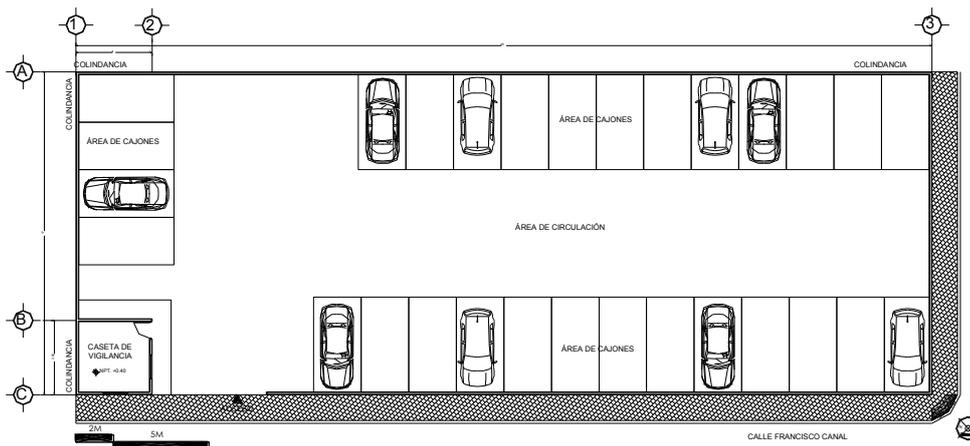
ESTADO ACTUAL Plano de estado actual del terreno.
